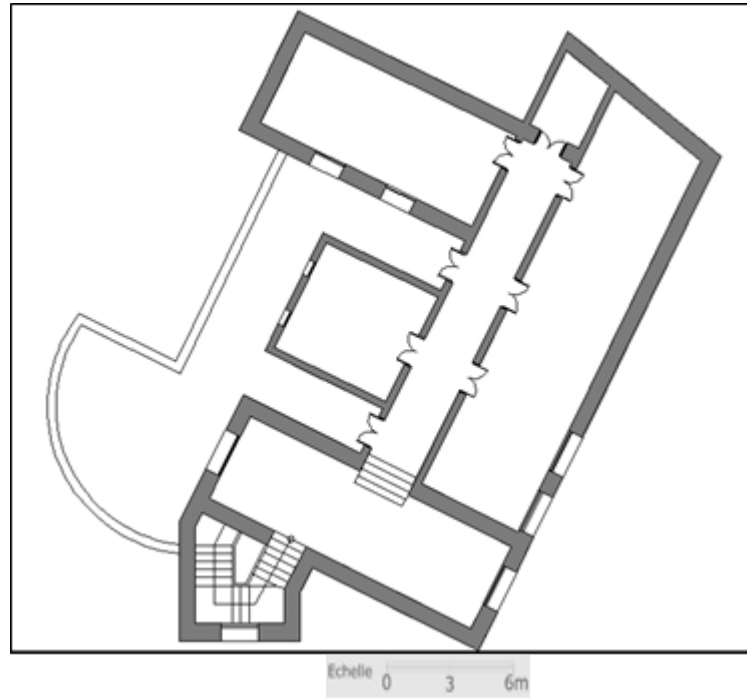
Plan du rez-de-chaussée (hall d'entrée et l'escalier principal de distribution)
